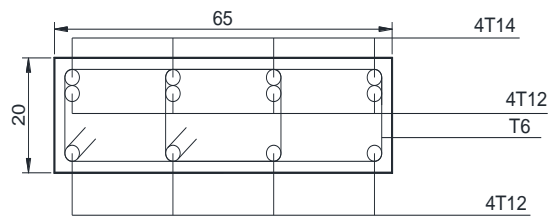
Coupe longitudinale d'une poutre noyée principale 65x20cm (plan fortement irrégulier)
